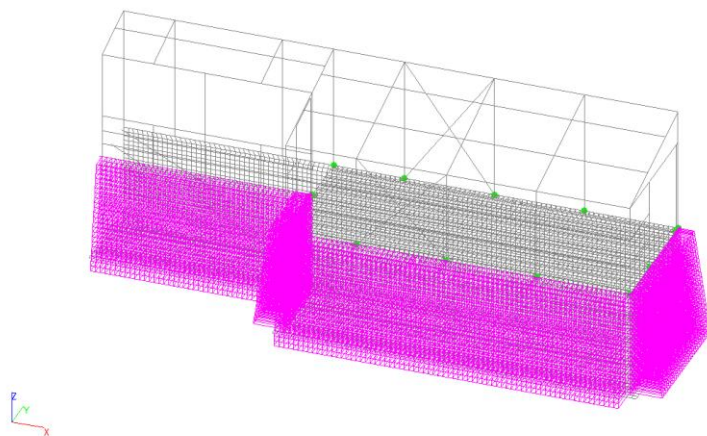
Расчетная модель лестницы, с применением сборных ж/б ступеней по стальным косоурам, загруженная давлением от грунта (вариант №3)
